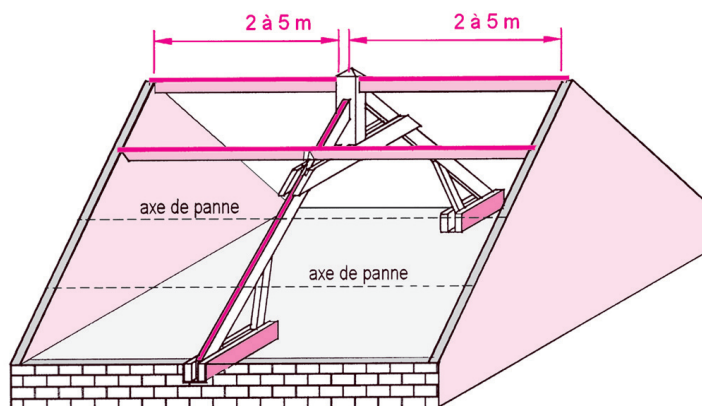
Charpente du comble avec ferme à entrait retroussé
